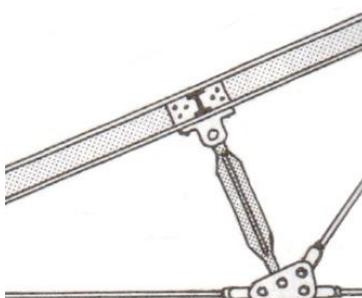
Bielle dans une construction métallique, image J. de Vignan [2]
